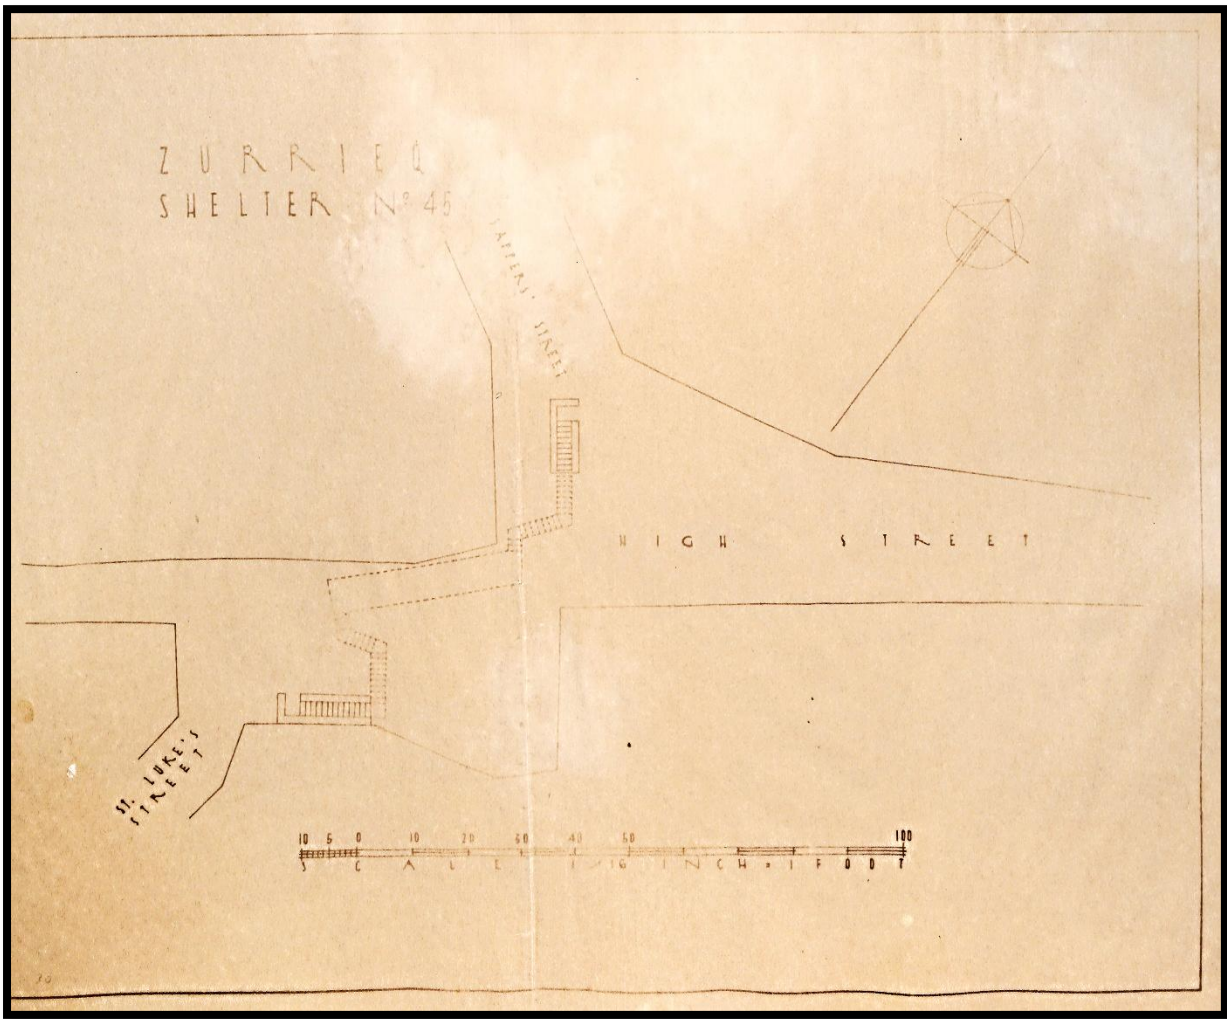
Planta do Abrigo nº45 "St. Luke's Street – High Street – Sapper's Street."
